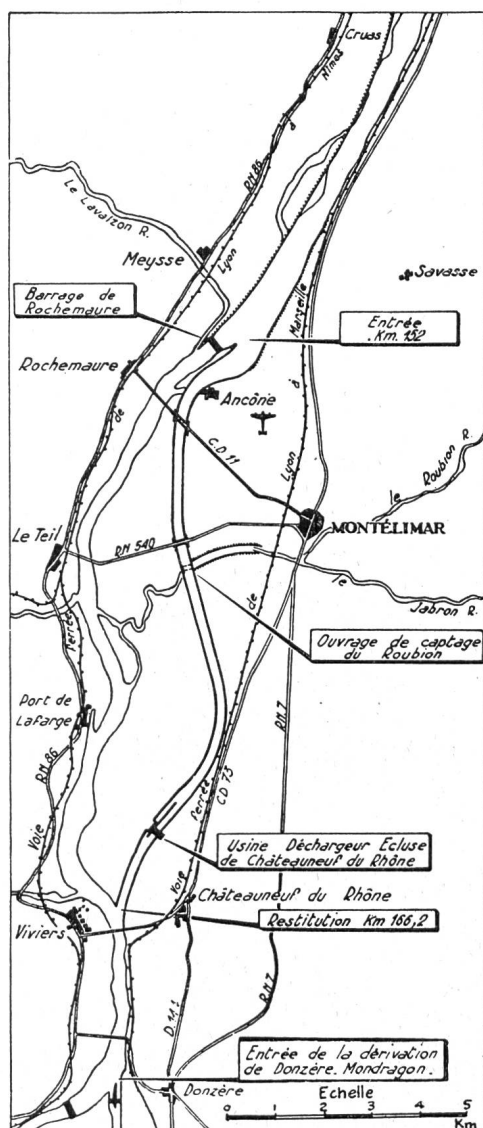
Lageplan des Rhonekraftwerks Montélimar
